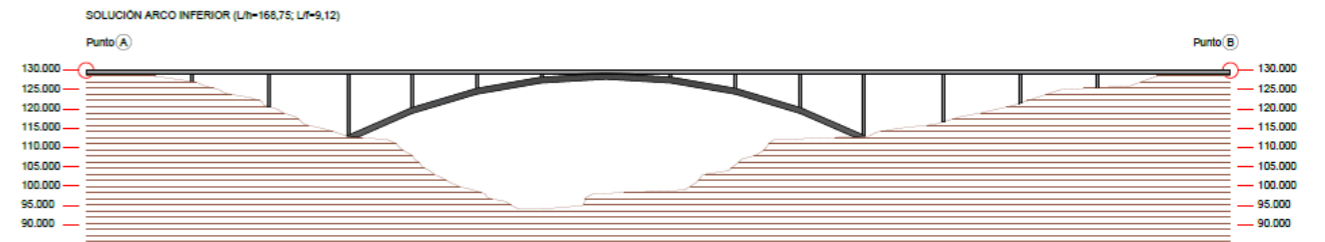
Alzado para solución arco de tablero superior. Fuente: Elaboración Propia (AutoCAD)
